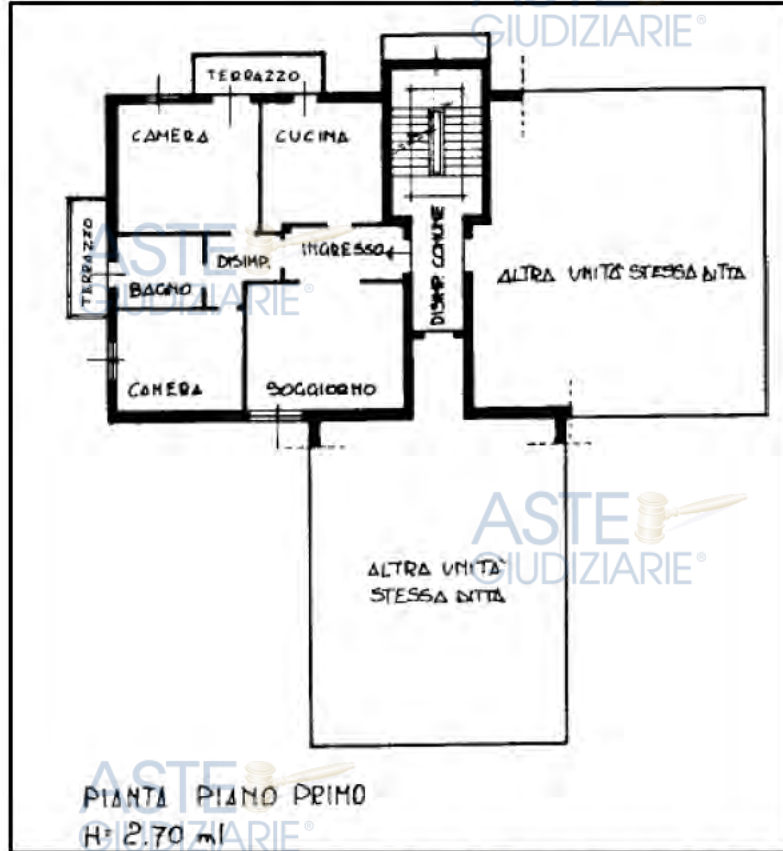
Estratto della scheda planimetrica dell'appartamento (Catasto Fabbricati)
